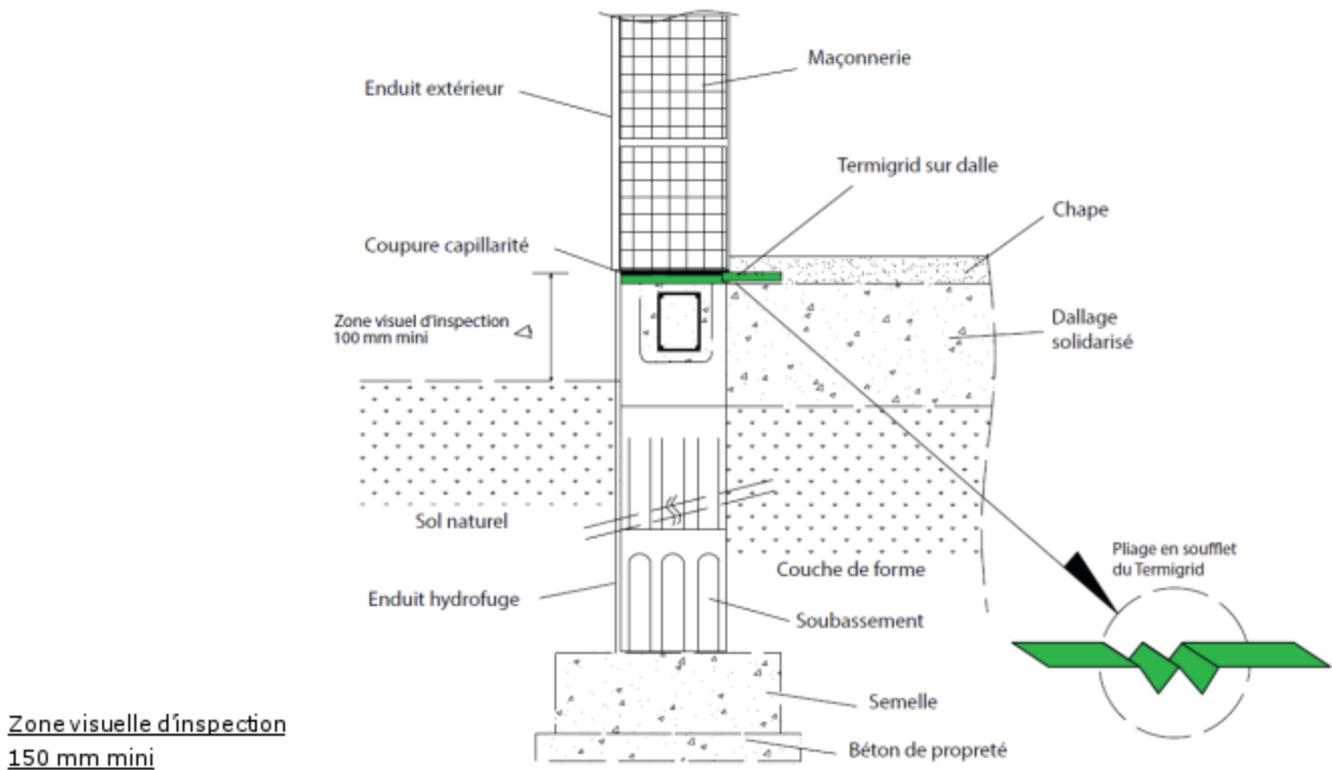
Coupe plancher bas coulé sur terre-plein
